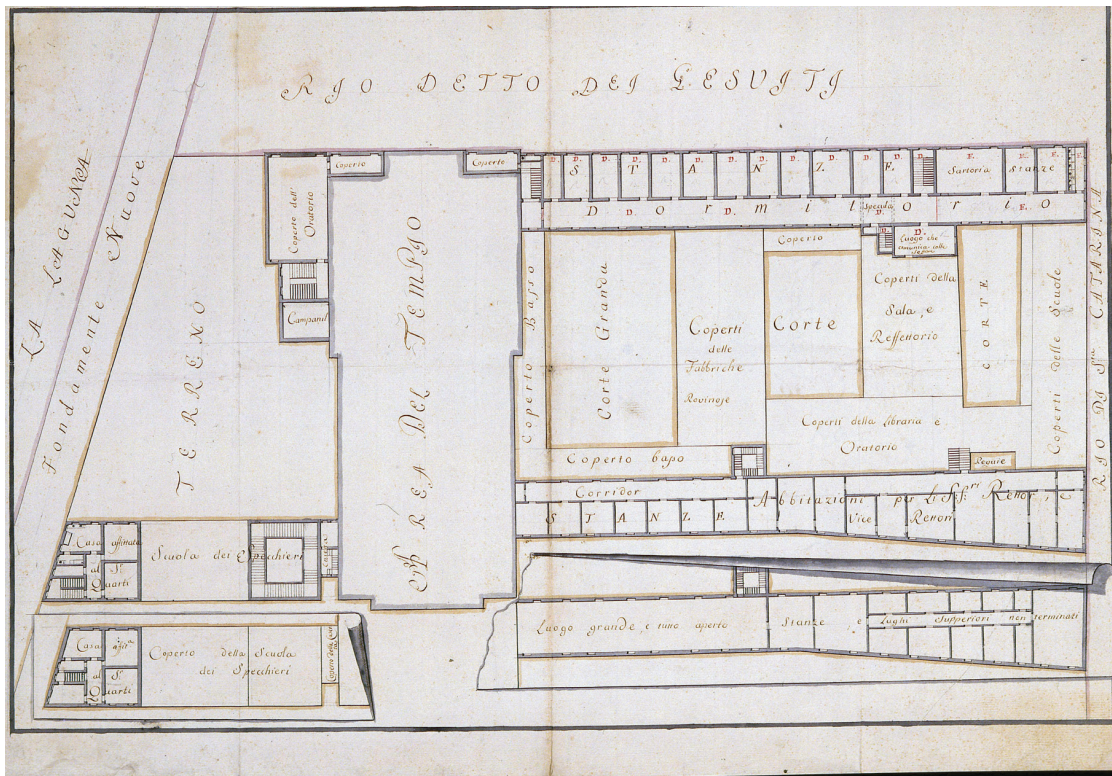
Planimetria del secondo piano dell'ex complesso dei Gesuiti, post 1773 (ASVe, Aggiunto sopra i monasteri, dis. 90)
